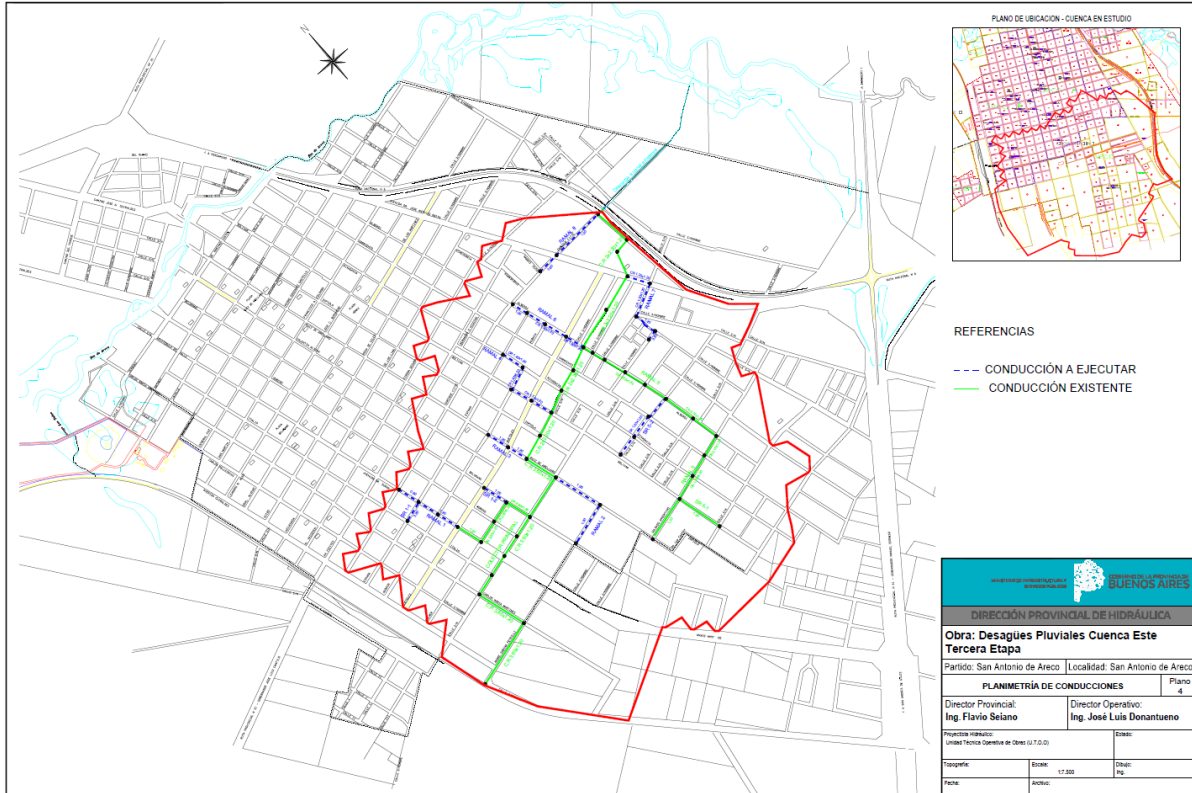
Planimetría de conducciones. En azul: conductos a ejecutar, en verde: conducción existente.
